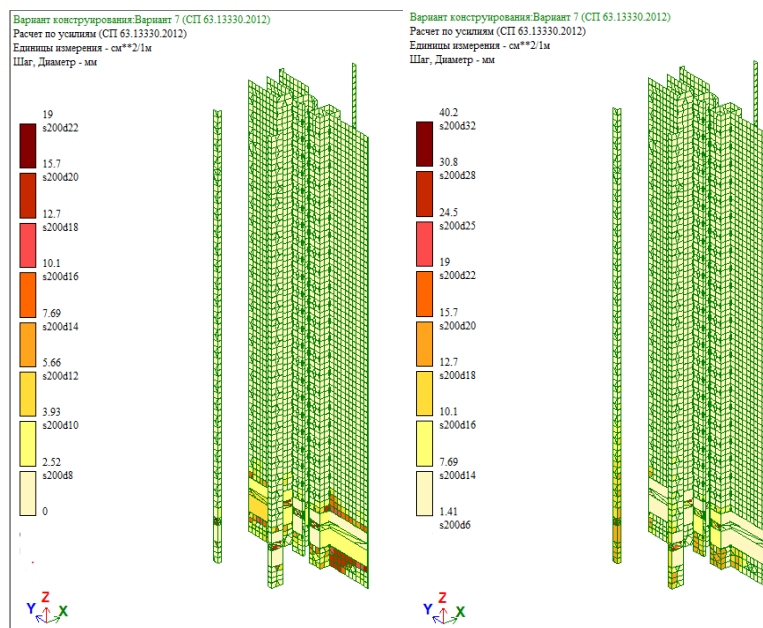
Схема армирования верха стен по оси OX, OY
